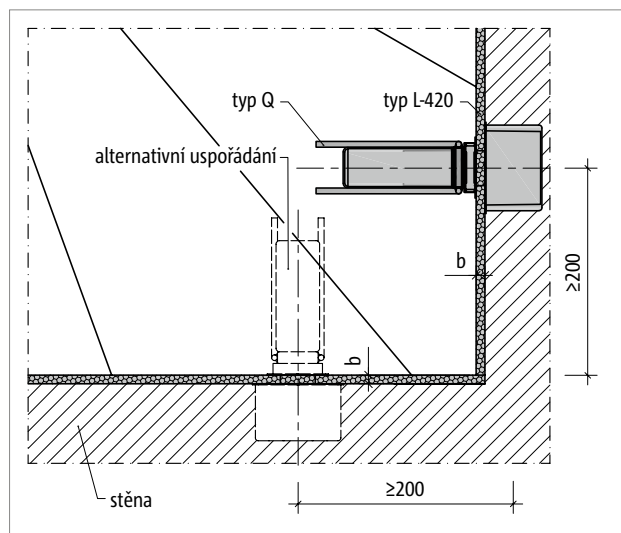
Schöck Tronsole® typ Q-FV-XL nebo Q-A2-XL: Řez napojením prefabrikovaného ramene
